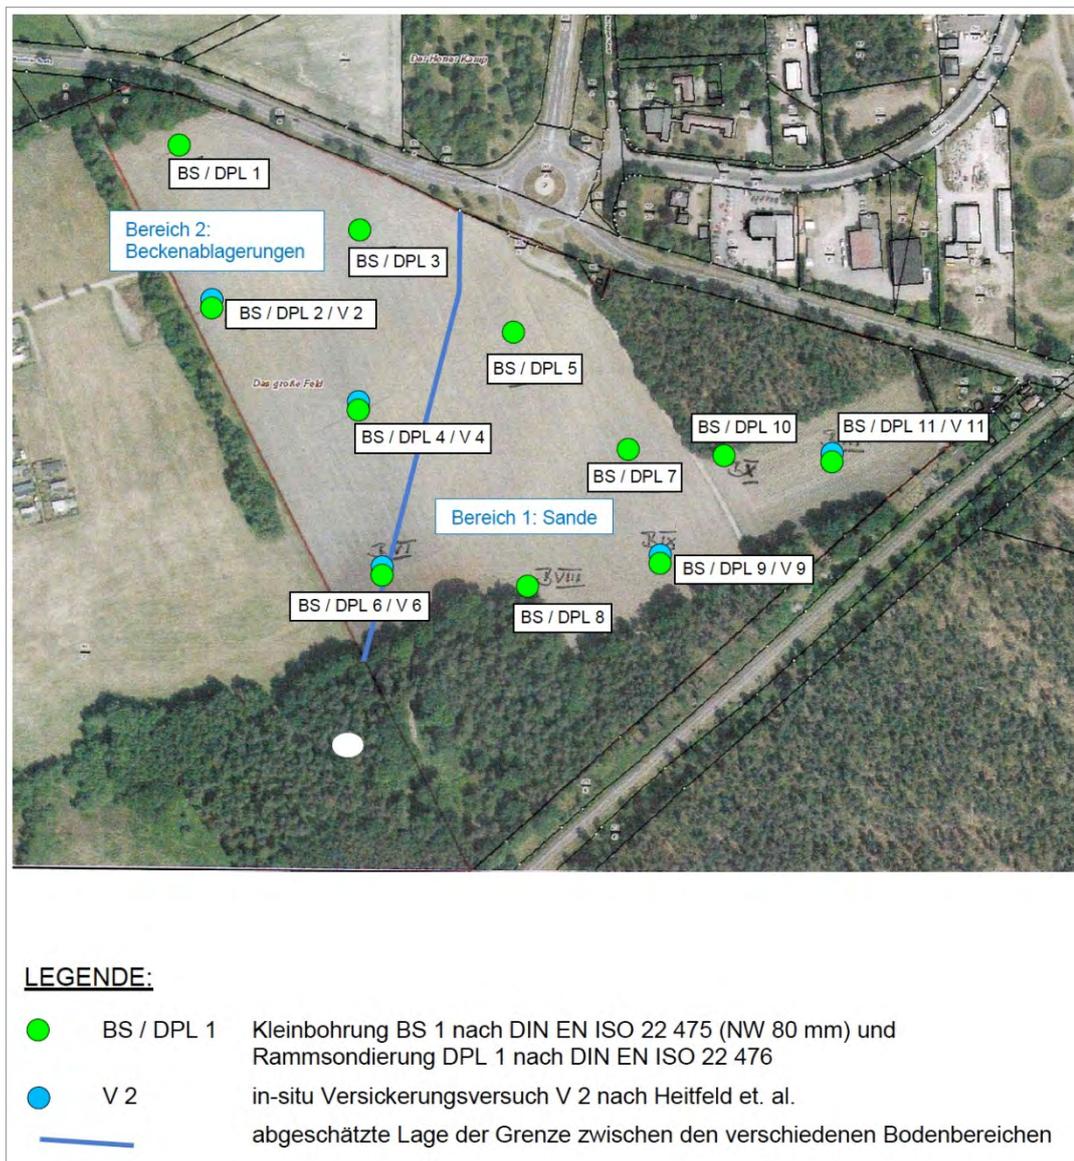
Lageplan Baugrundbeurteilung. Quelle: Baugrunduntersuchung Michael Beuße mbH, 2019.
